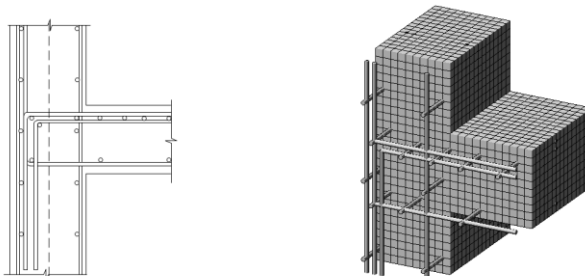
Фрагмент трехмерной модели узла примыкания перекрытия к диафрагме
